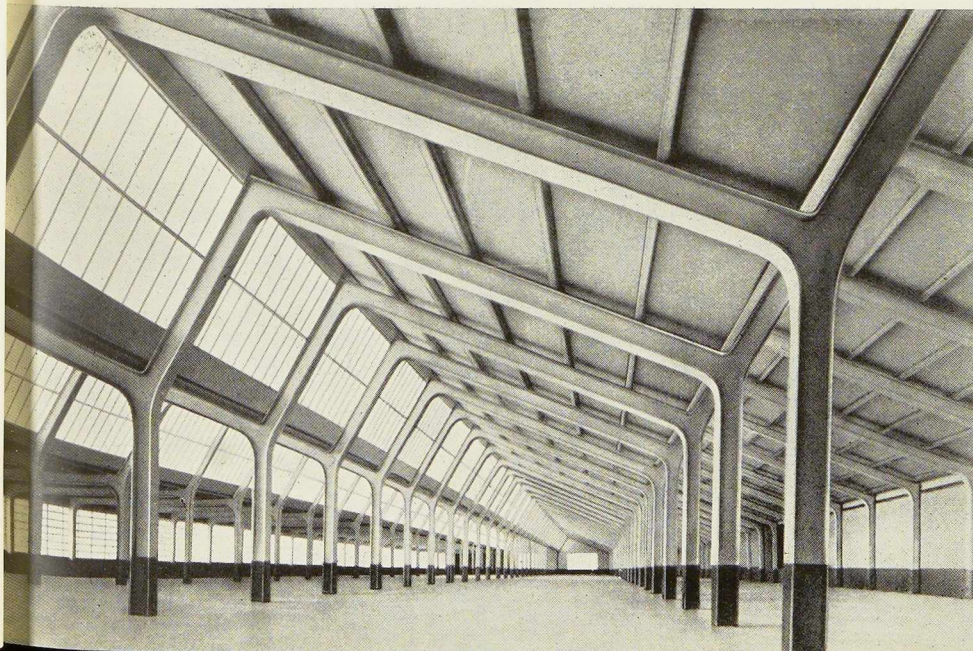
Une nouvelle charpente soudée pour bâtiments industriels a été dernièrement réalisée aux Etats-Unis, par la Austin Company de Cleveland (Ohio).
